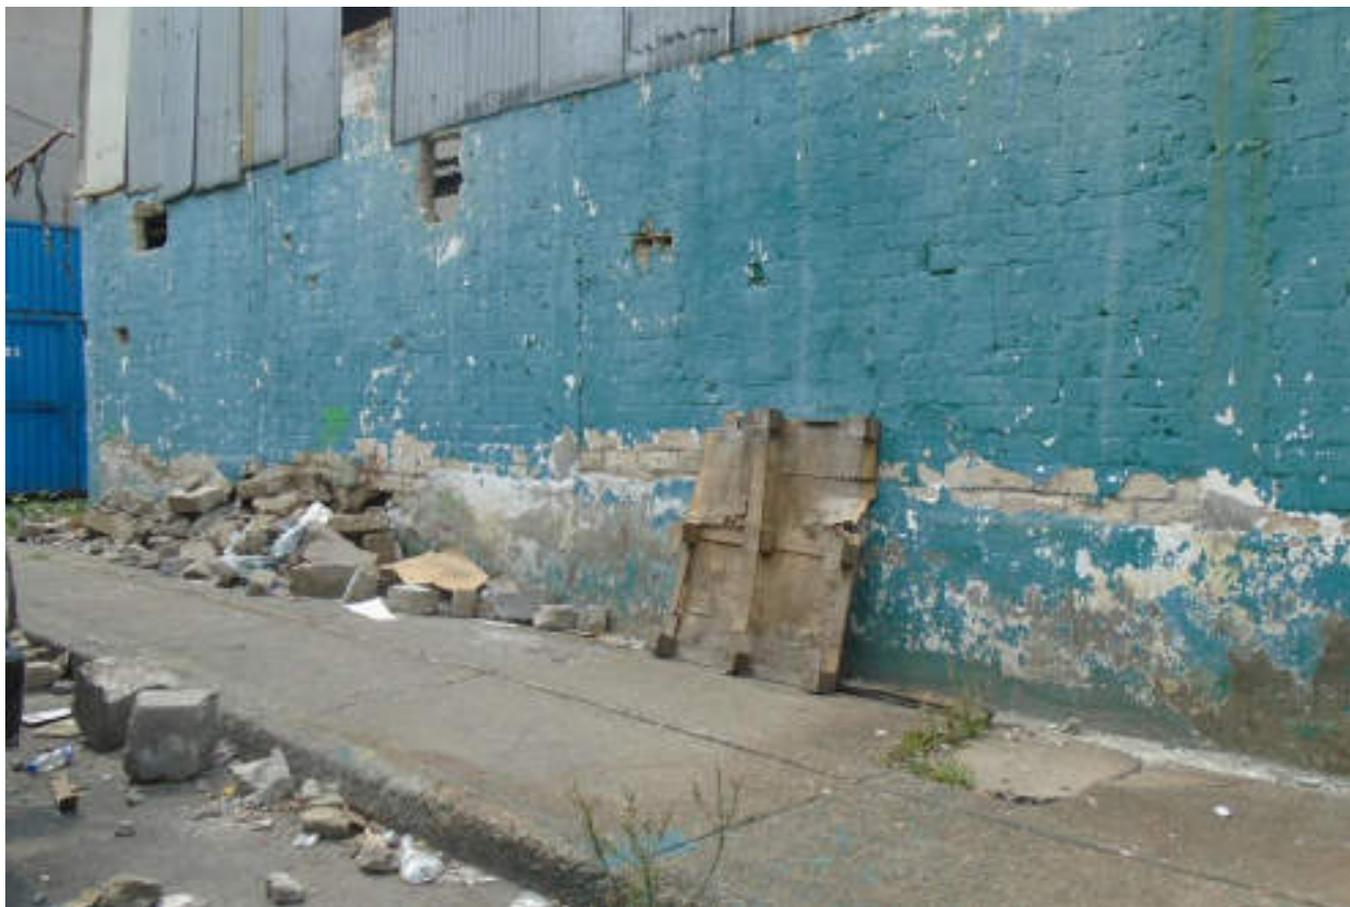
Fotografía A (Imagen 27), muro de mampostería no confinado que presenta desprendimiento del tabique en la parte inferior, ocasionando que la estructura pierda estabilidad y resistencia (19.4763184602° N, 99.184706822° W. Calle: Primera Privada Recreo).
